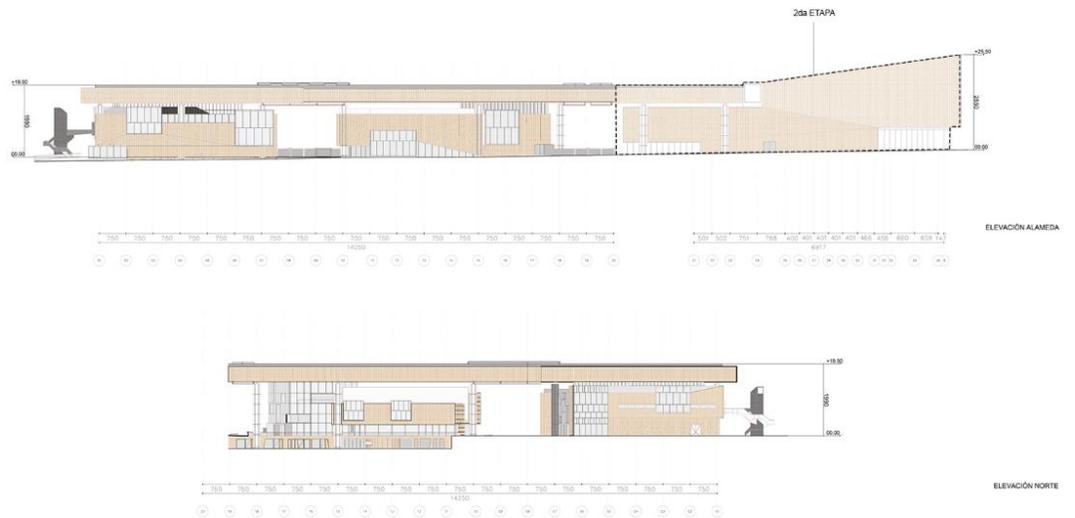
Elevación Alameda (Arriba), Elevación Norte (Abajo).
